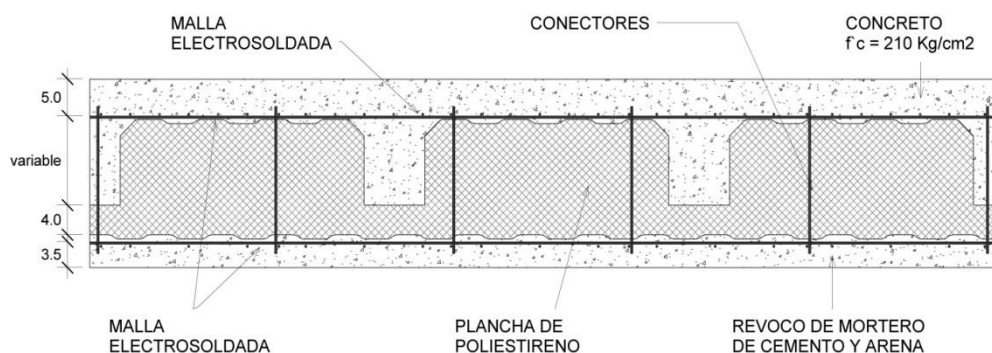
Panel forjado con tres nervaduras para armado de viga PL₃
